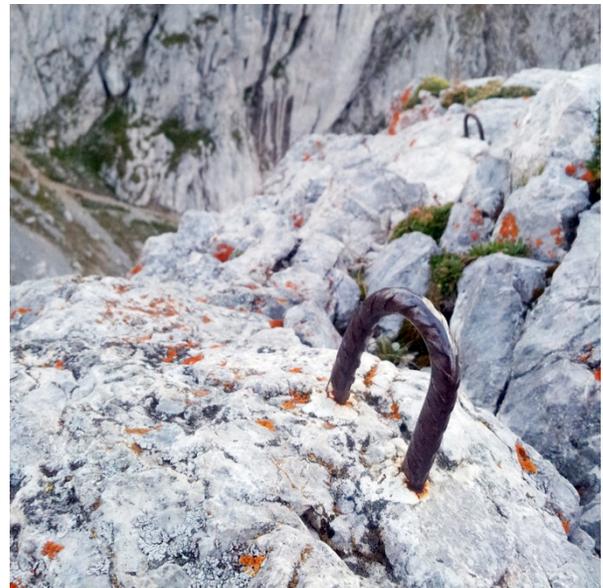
Montagewerkzeug für Verbundbohrhaken Abb. 63 Torstahlbügel auf der westl. Edelspitze
